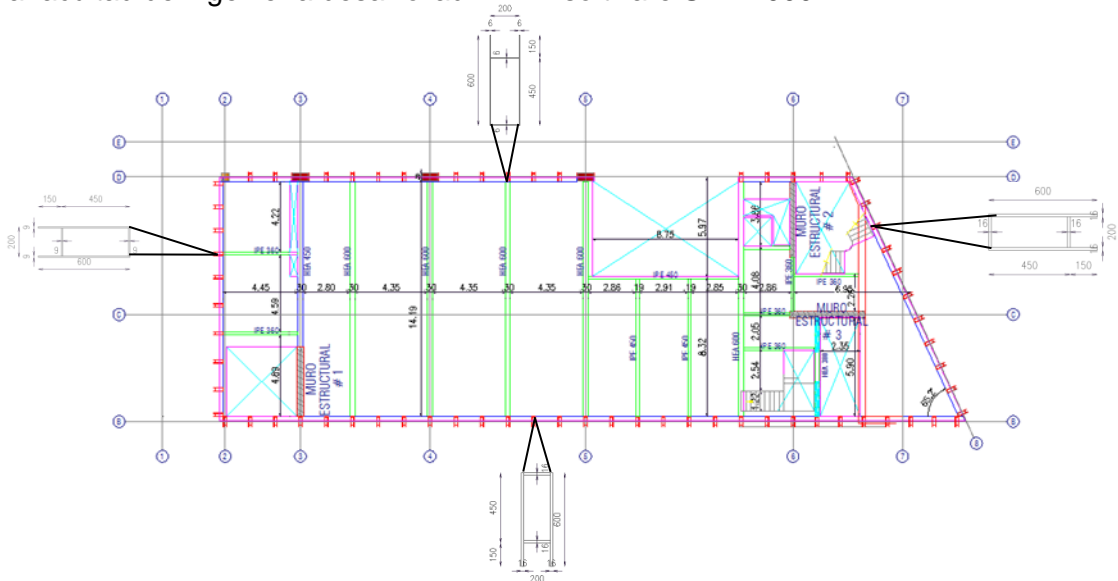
Planta típica del piso 2 ubicada a N + 3.20
